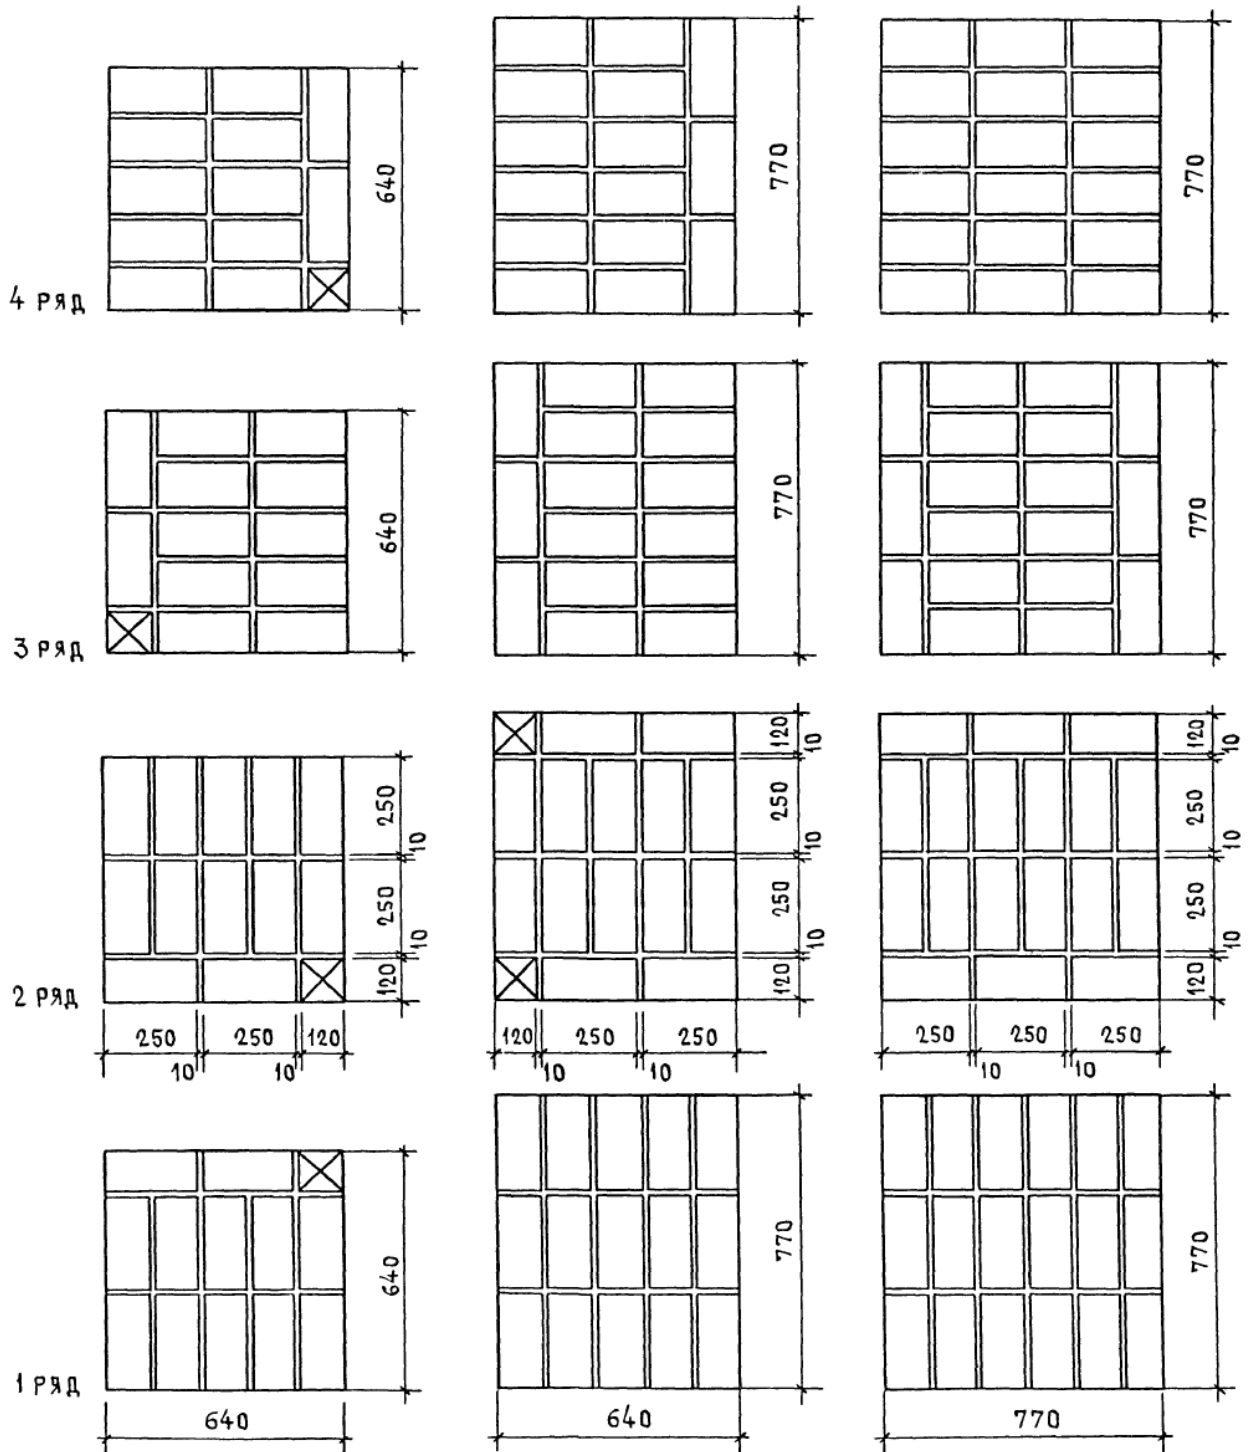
Перевязка кладки кирпичных столбов сечением 640×640 мм, 640×770 мм, 770×770 мм
